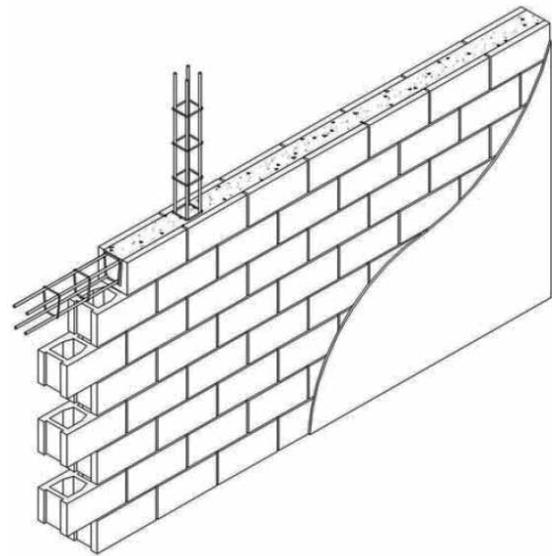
Muro de bloque con el hormigón dispuesto en los zunchos y pilastras armadas con barras.
